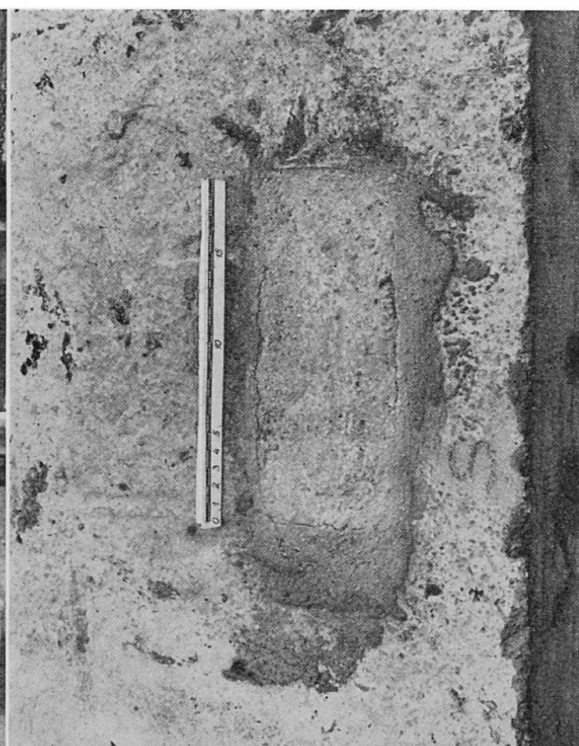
Schwindrisse zwischen Mörtelfüllung und Fertigbetonplatte (1 Tag nach dem Ausgießen der Öffnung).
